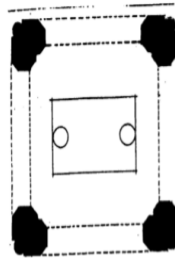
مسقط أفقي لمقصورة الدفن الخاصة بمدفن محمد حافظ بك إبراهيم.
